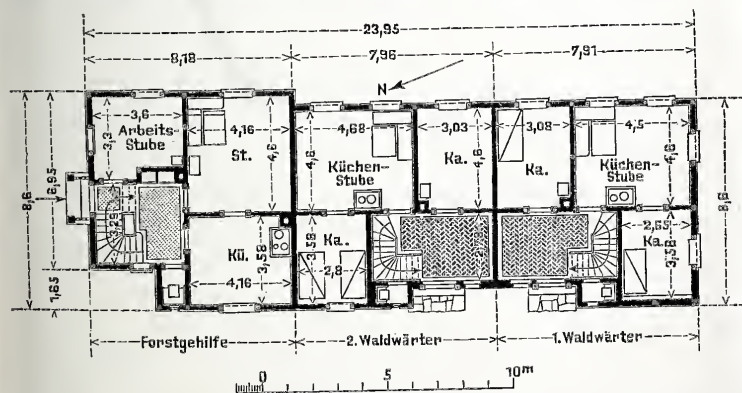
Grundriß der Wohnhausgruppe für zwei Waldwärter und einen Forstgehilfen in Steinbach b. Jöhstadt.
